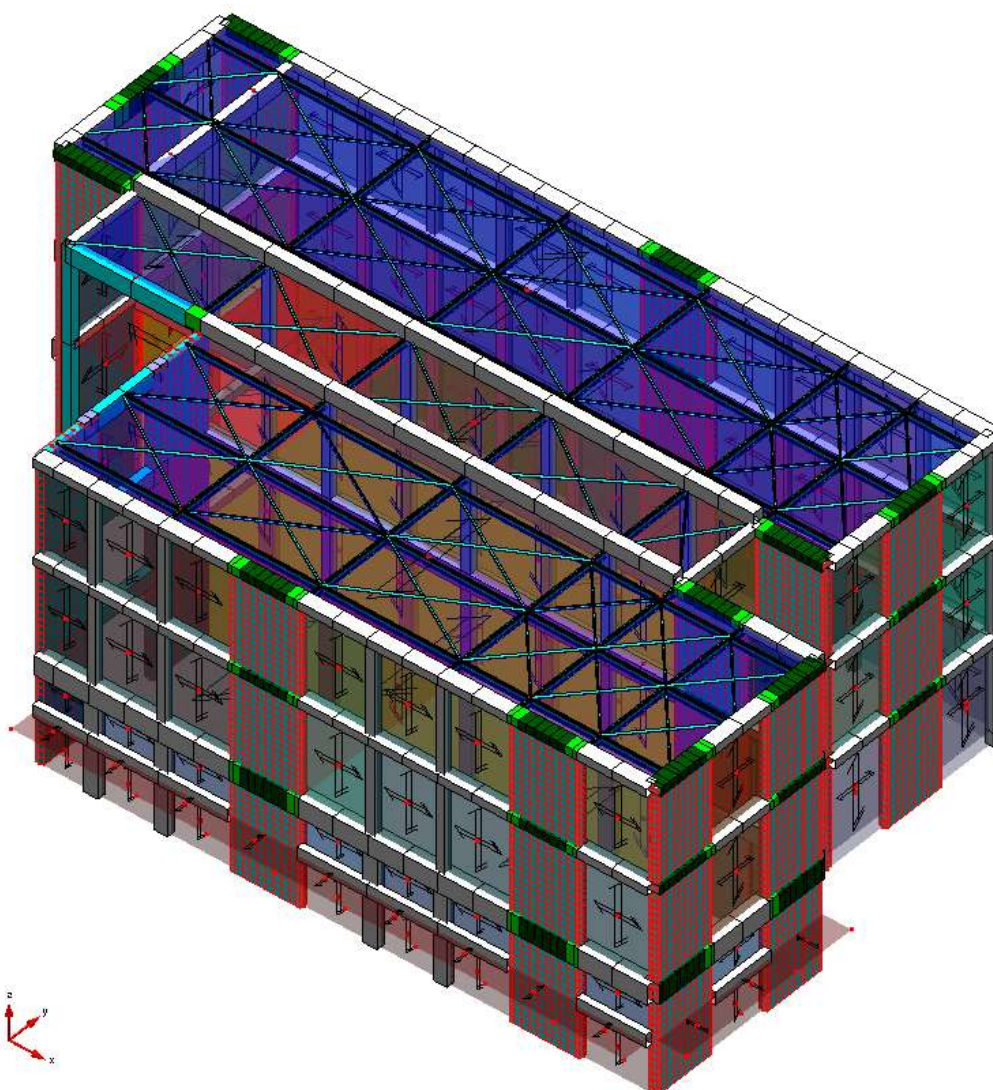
Vista in prospettiva 3D del modello di calcolo.
